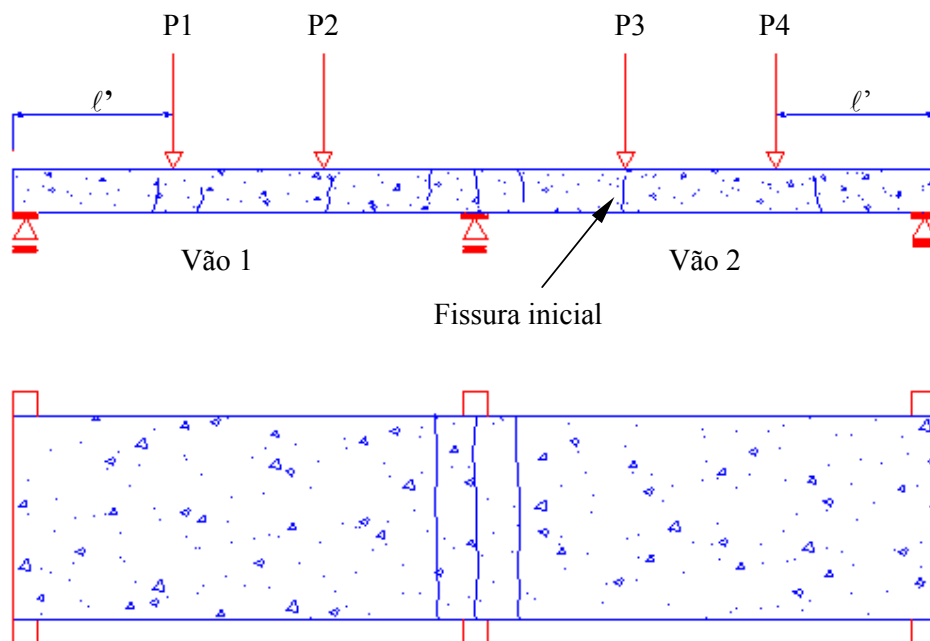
Perfil das fissuras no protótipo P1S2A
